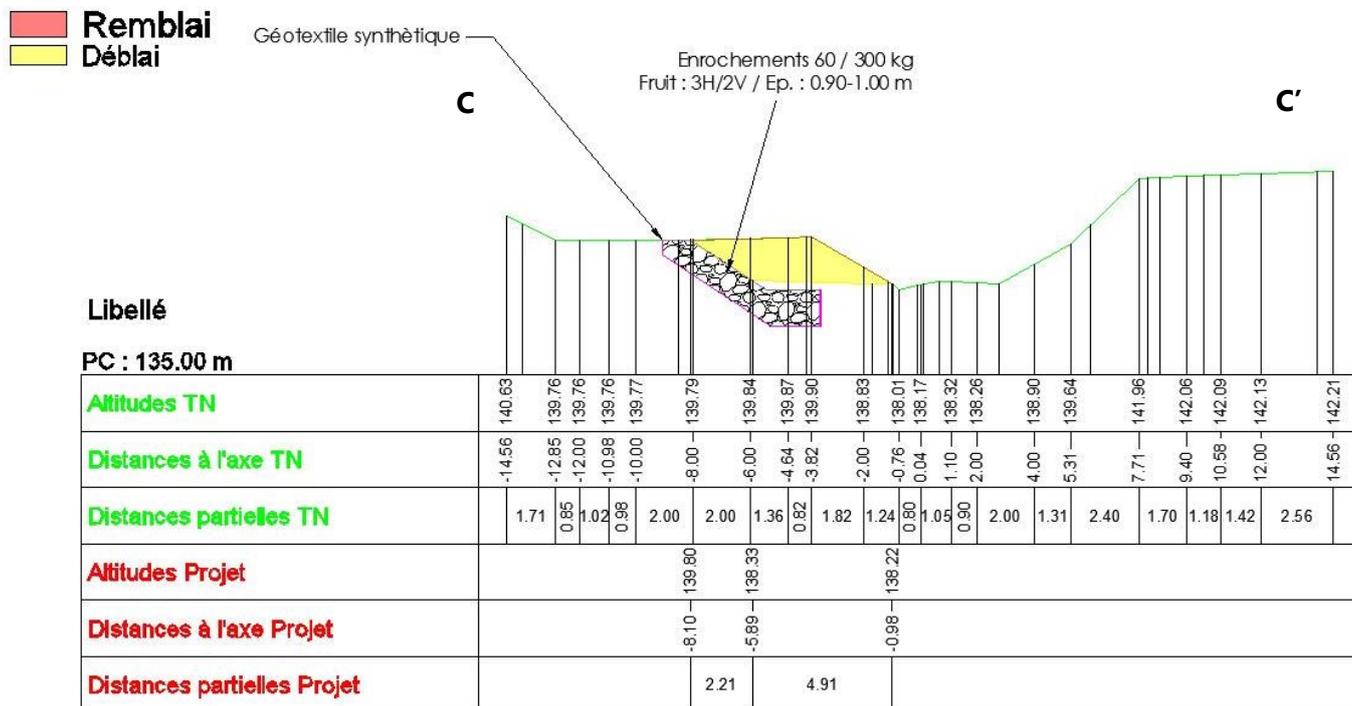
Profil en travers de l'aménagement du coude en aval de la zone d'implantation du cimetière
